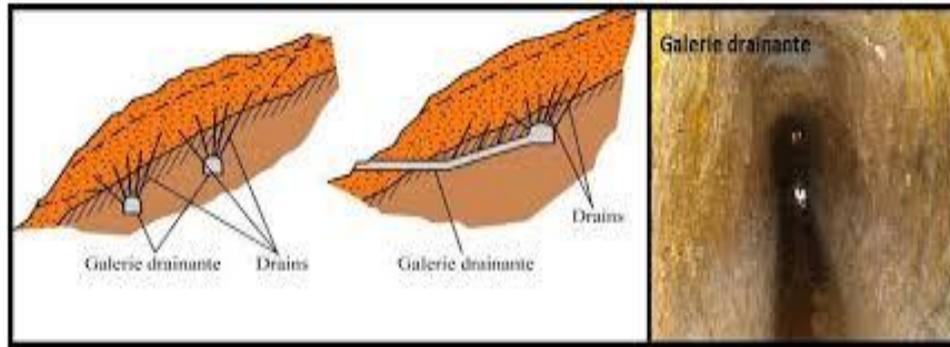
Disposition et connexion des drains avec la galerie drainante
